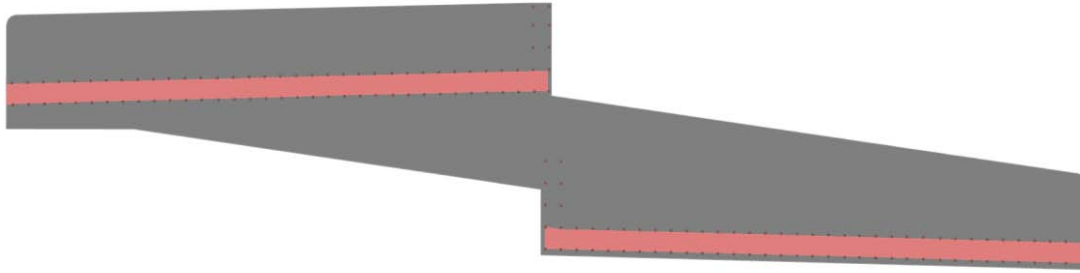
Ansicht auf Rampenträger außen - beim Anschluss der Geschoßdecken und Brüstungen
